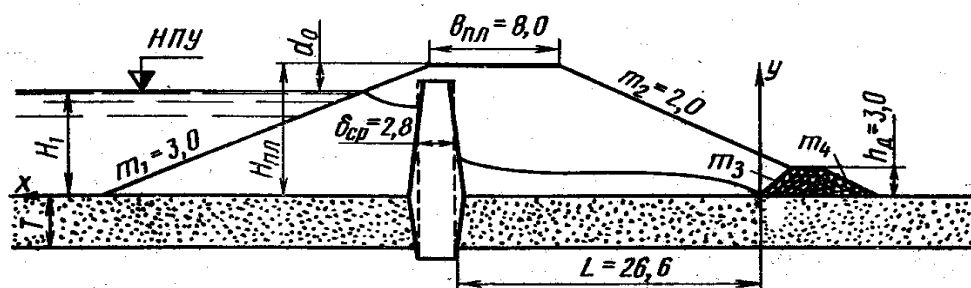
Расчетная схема фильтрации через грунтовую плотину с ядром и дренажем на водопроницаемом основании при отсутствии воды в нижнем бьефе.
